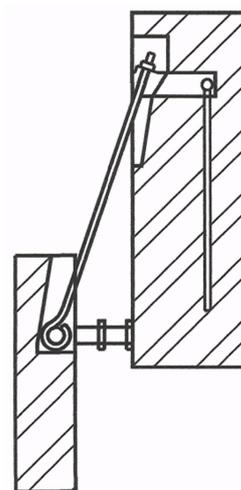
Пример анкерного закрепления фасадных плит из железобетона
